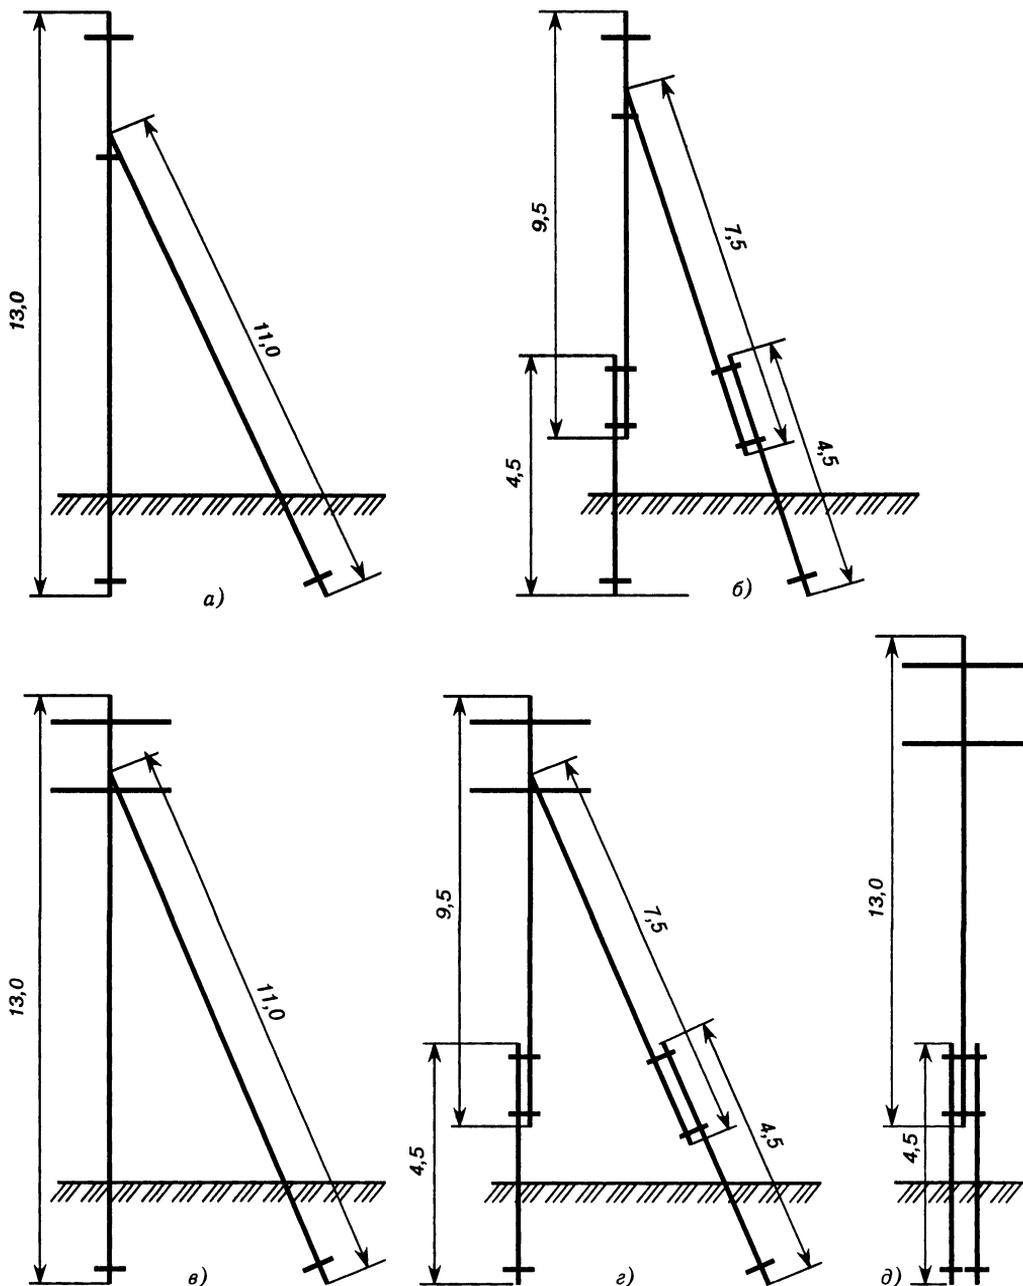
Схемы деревянных опор для совместной подвески проводов ВЛ 0,4 и 10 кВ по типовому проекту 3.407-92.
